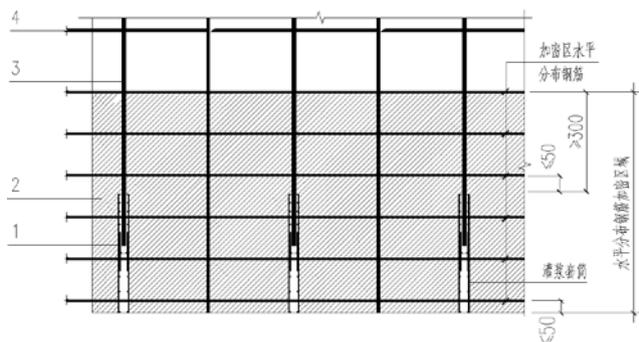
竖向钢筋连接区域加密水平钢筋构造
